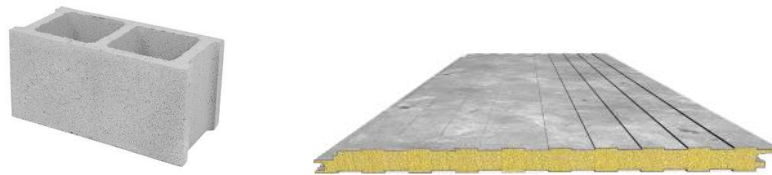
Bloque de hormigón y panel sándwich
